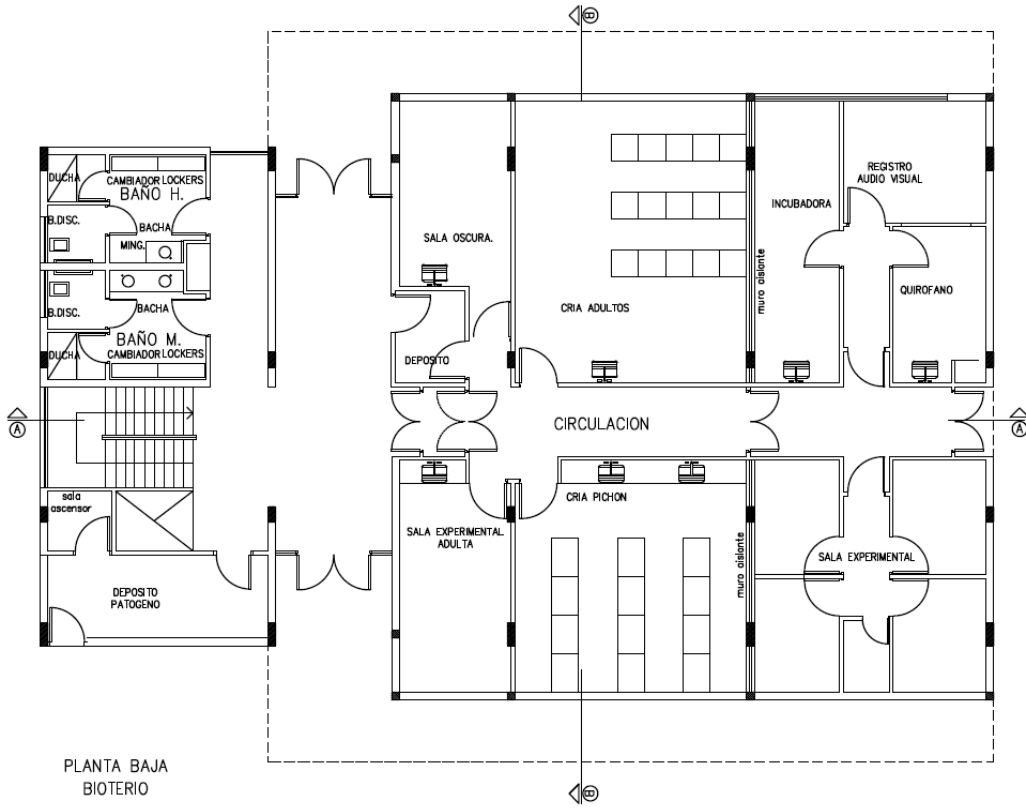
Plano de arquitectura- Edificio Bioterio-Planta Baja
